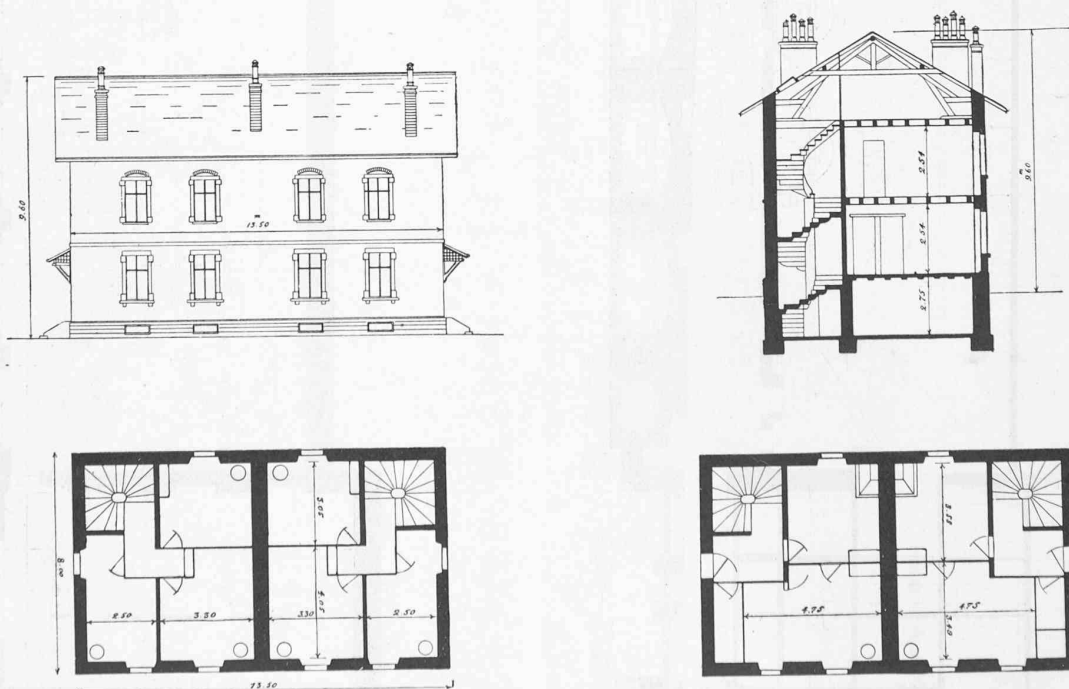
Maison d'habitation des deux principaux machinistes. — Echelle : 1 : 250.
